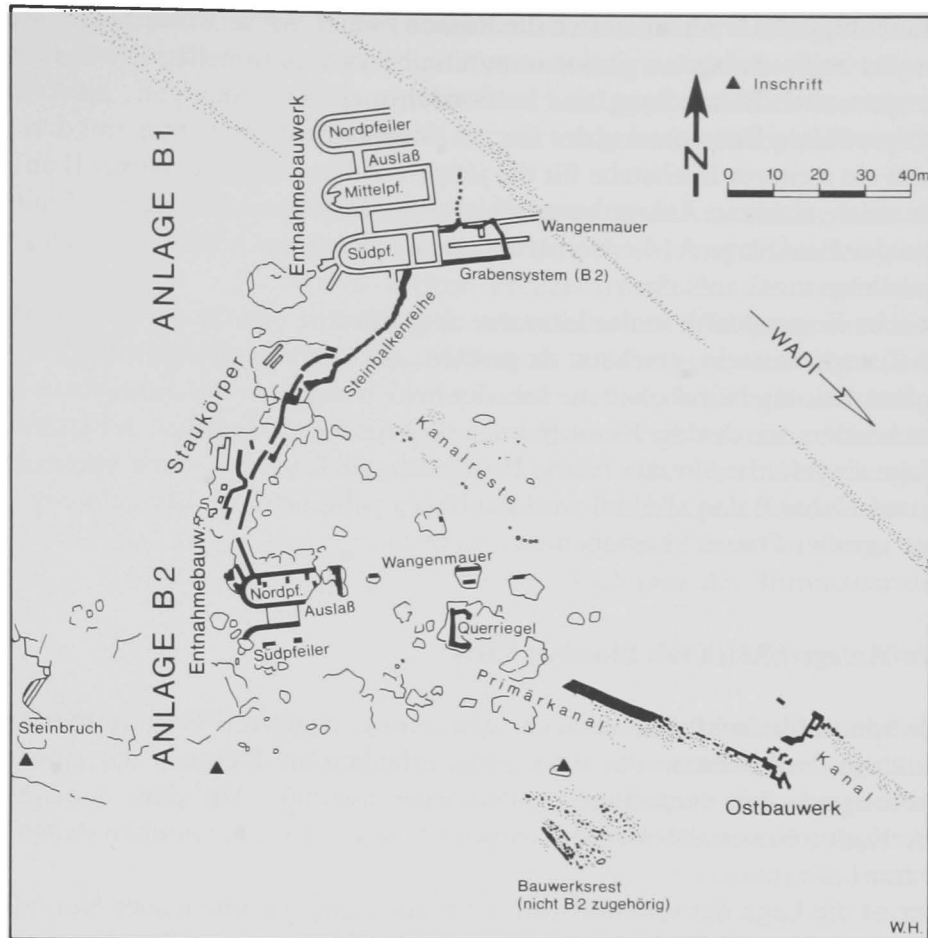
Lageplanskizze des Baukomplexes B, mit den Anlagen B 1 und B 2.
